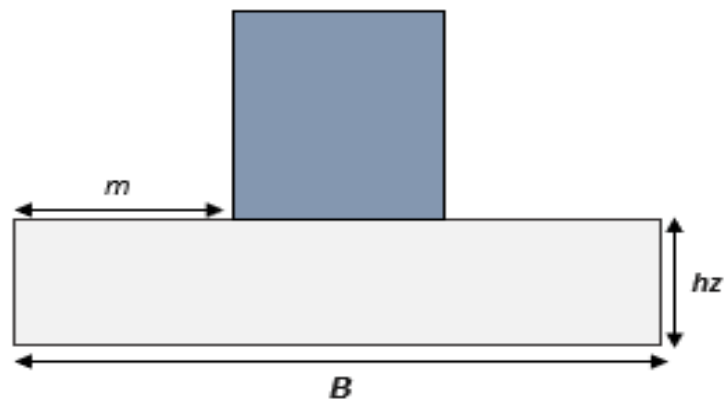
Vista elevación de zapata y columna. Elaborada por la autora.
